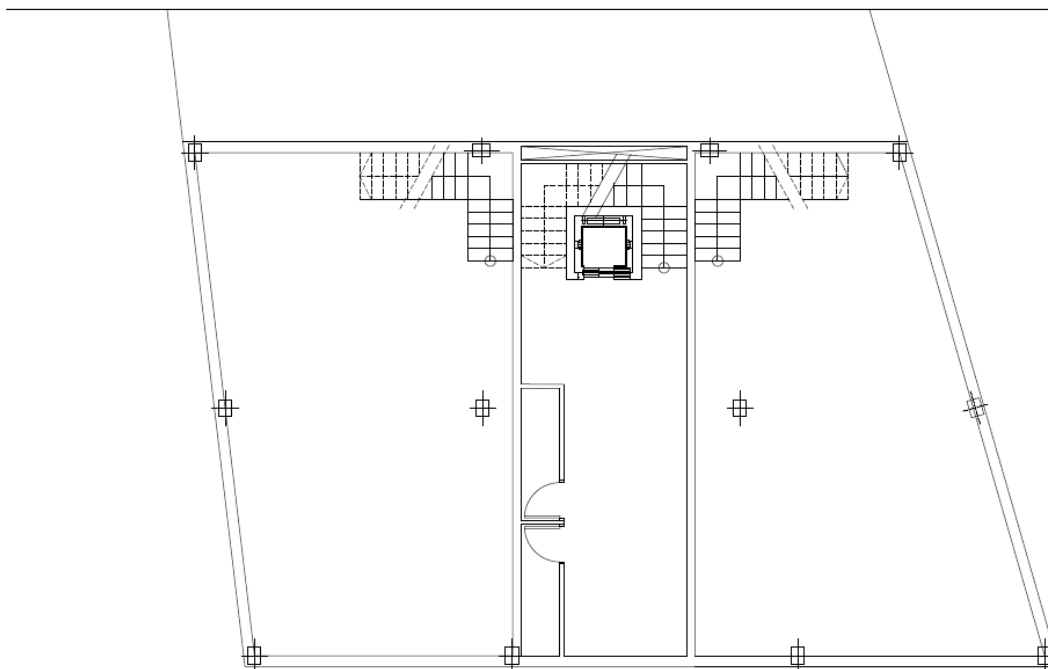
Distribución Planta Baja. Fuente: Propia (2019)
